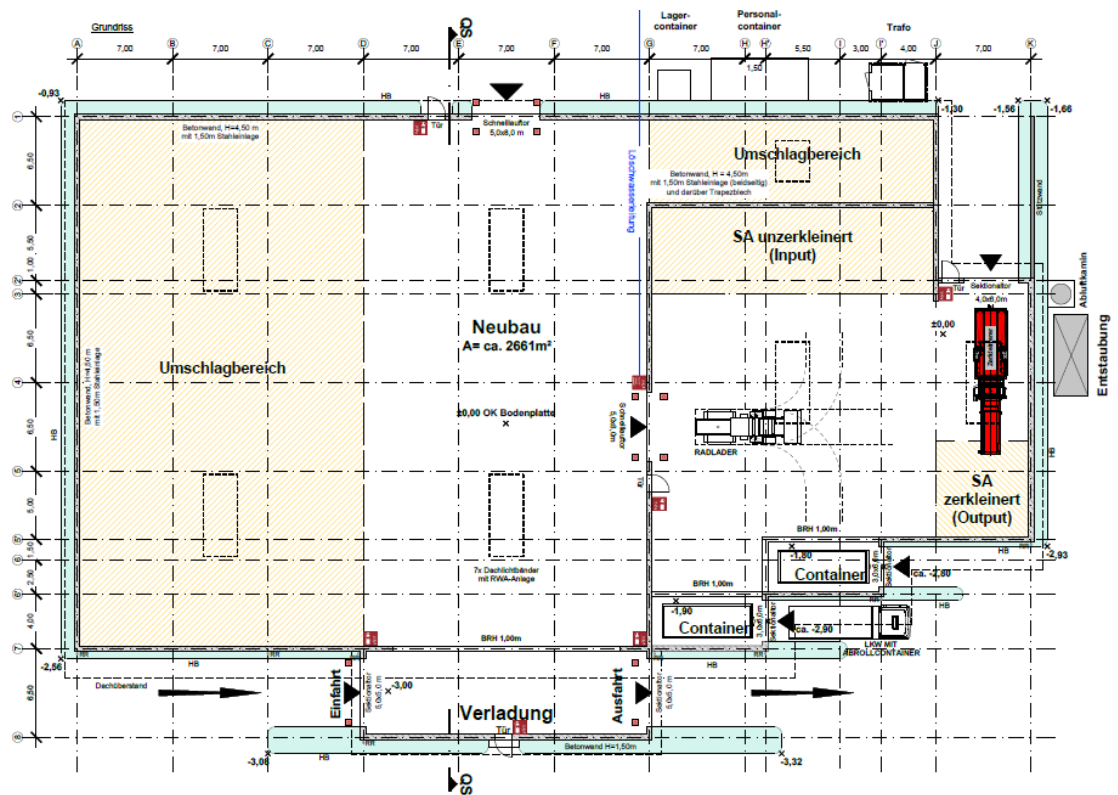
Plandarstellung der geplanten Umladestation mit Sperrabfallzerkleinerung, Draufsicht.
